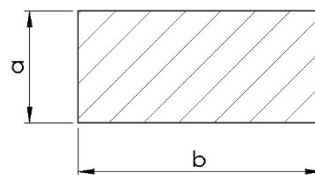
Geometría de la sección de la viga central (Fuente: propia)
